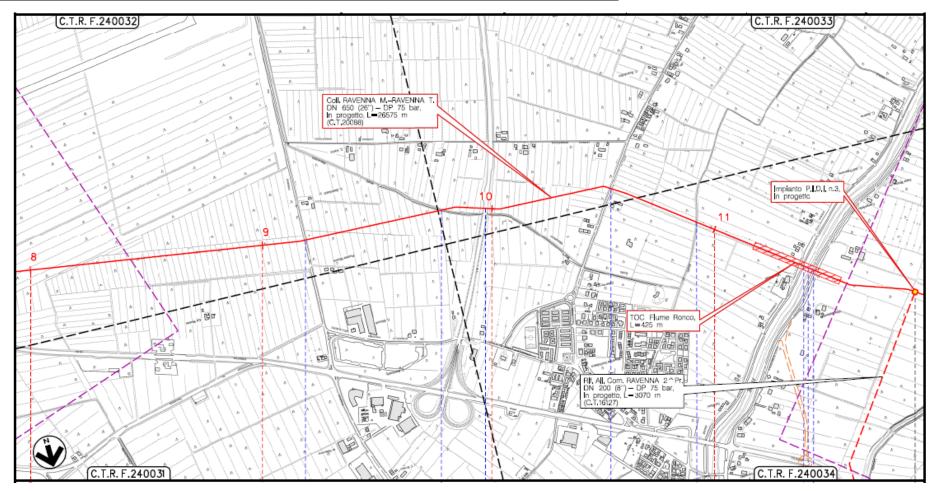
Stralcio planimetria CTR con localizzazione dell'area di intervento
